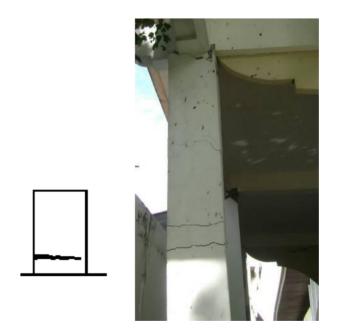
Grietas por flexión: a) esquemático; b) en columnas
